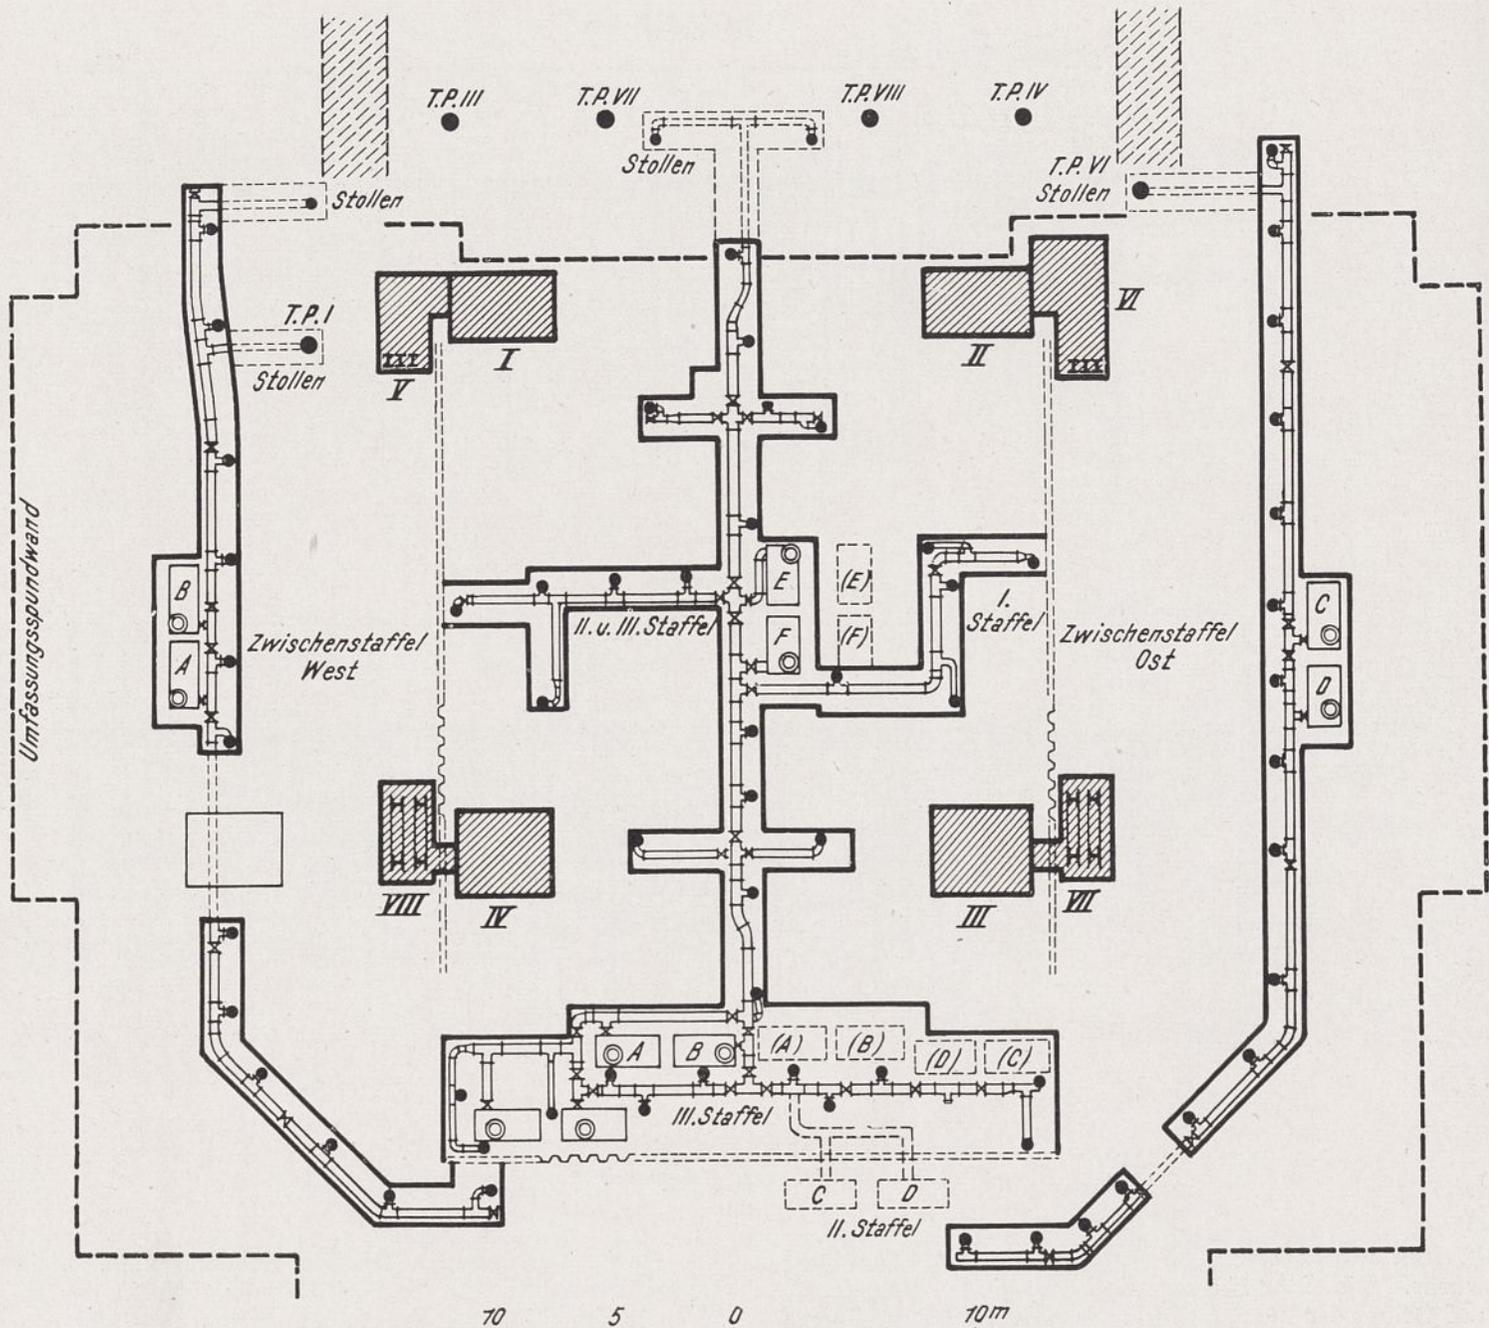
Grundriß der Grundwasserabsenkungsanlage.
